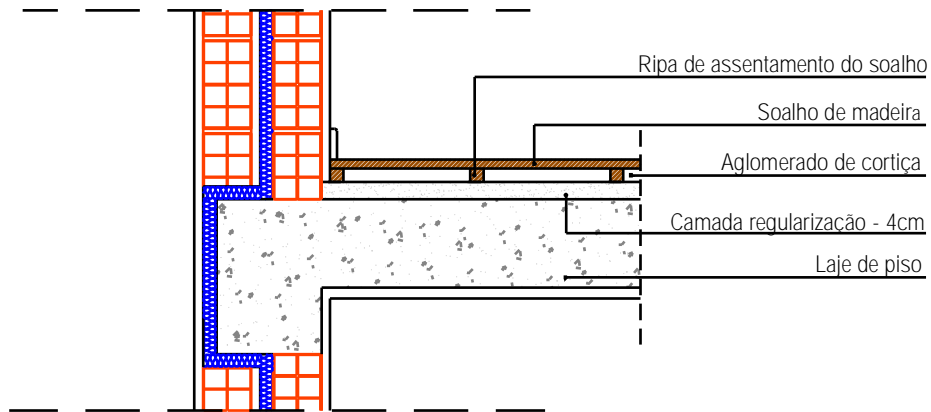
Constituição de laje de piso (pavimento)
